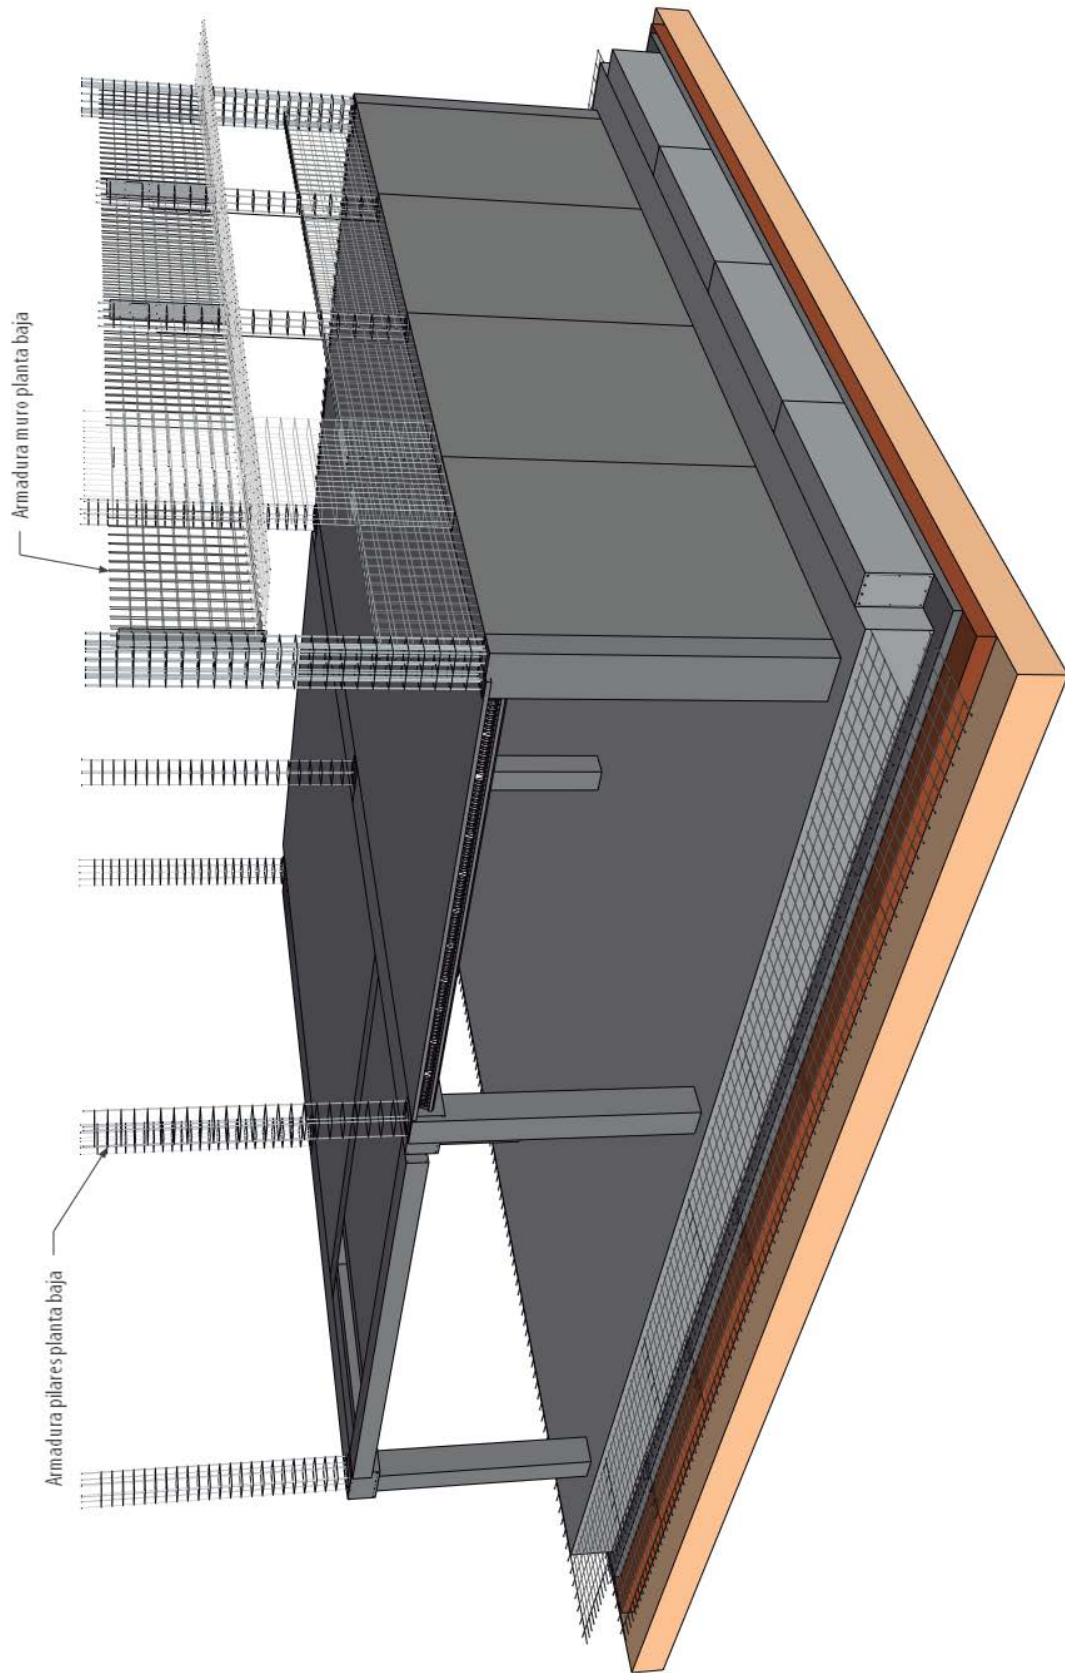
Colocación de las armaduras de los pilares de la planta baja y del su muro
